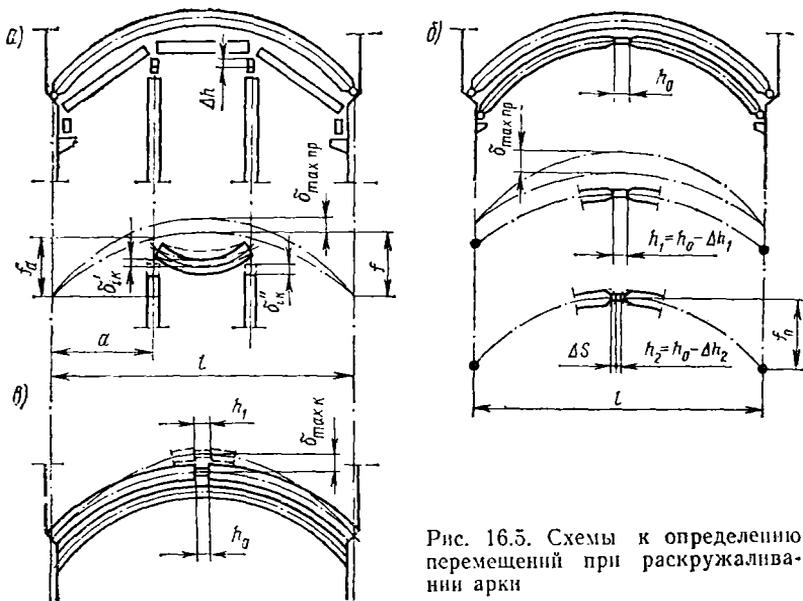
Схемы к определению перемещений при раскружливании арки
